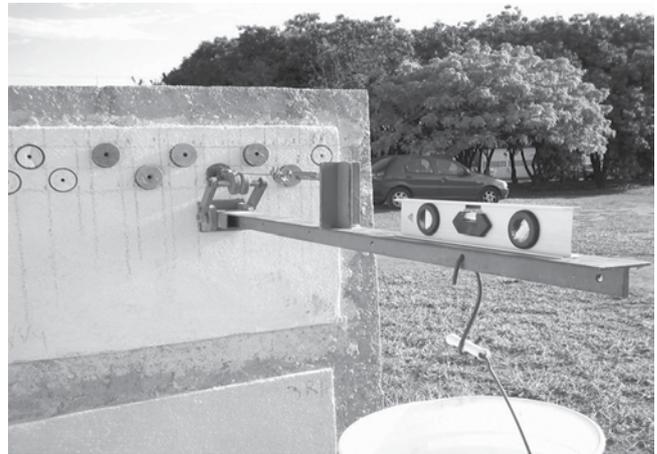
Equipamento mecânico para ensaio de resistência de aderência à tração das argamassas deste estudo aplicadas em painéis cujo substrato foi o bloco de cimento.
